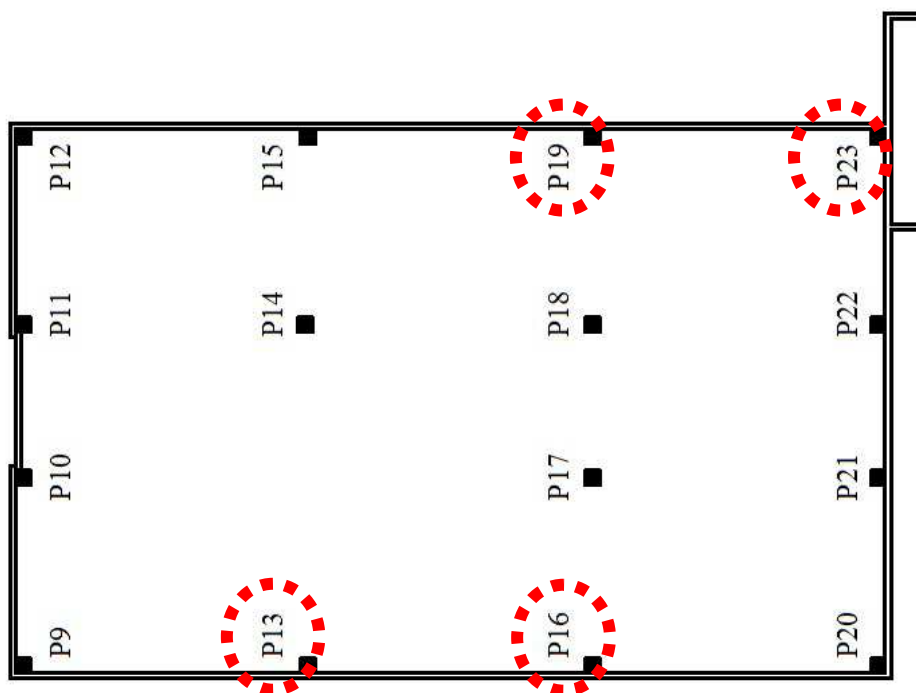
Schema planimetrico padiglione EXPO con evidenza pilastri non verificati
